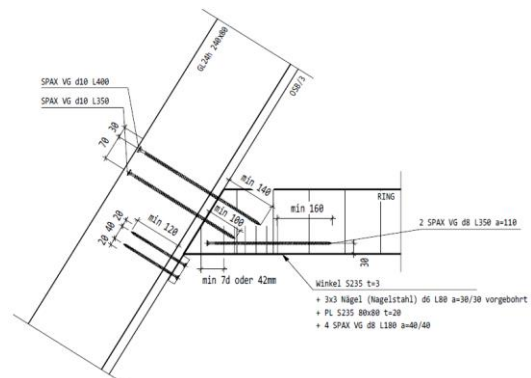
Sparrenanschluss SBlumer ZT GmbH
